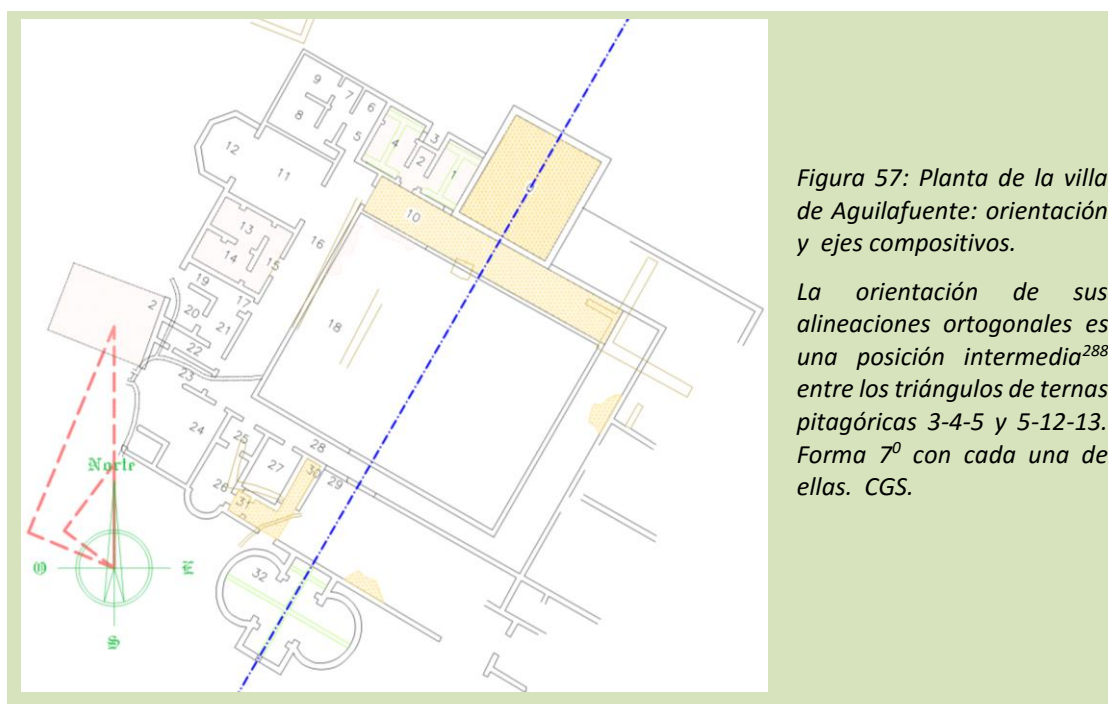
Planta de la villa de Aguilafuente: orientación y ejes compositivos.
